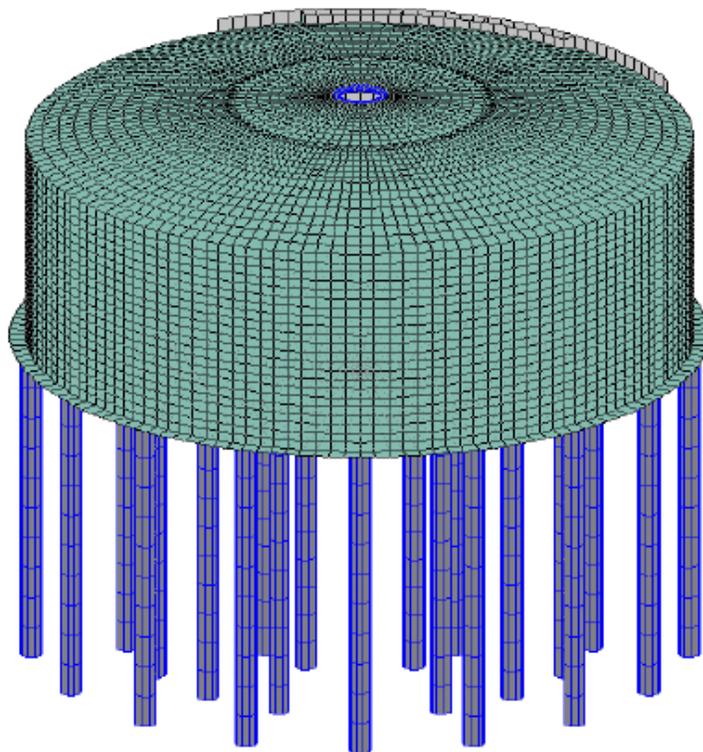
Cimentación de digestor por medio de pilas de concreto
